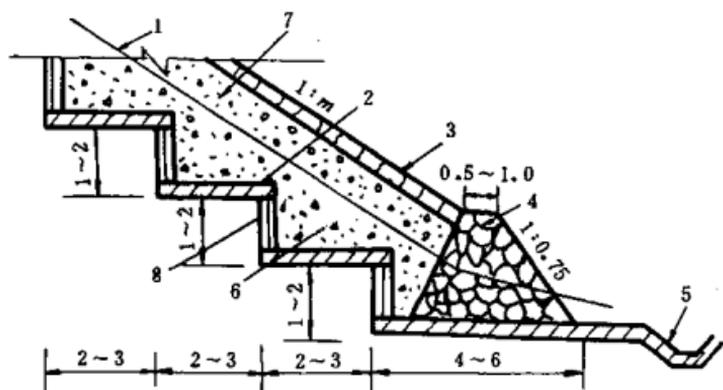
边坡渗沟布置和构造示意(尺寸单位:m)
